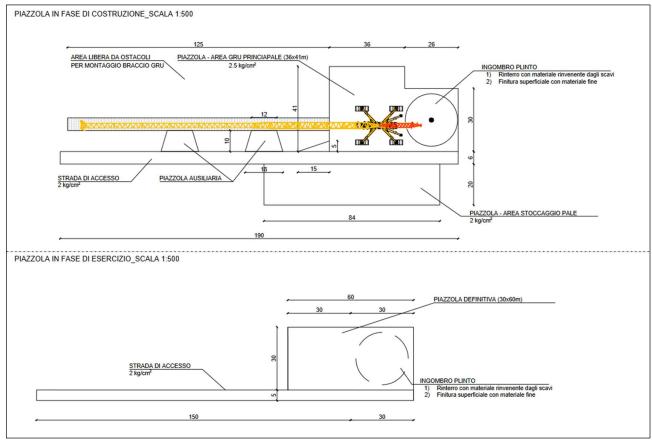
Planimetria piazzola tipo per la fase di installazione e fase di esercizio e manutenzione
